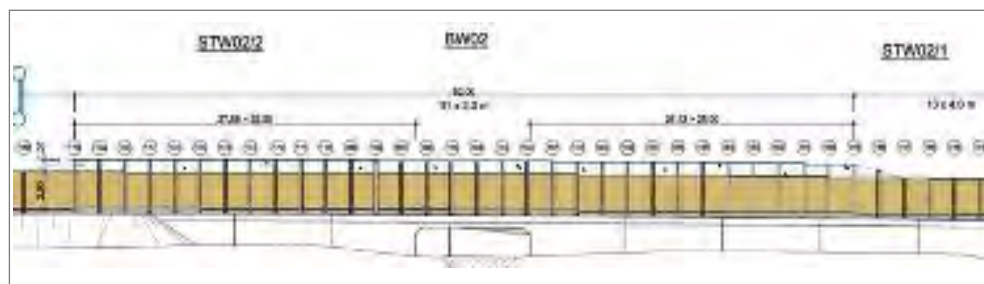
Ausschnitt Bauwerksplan Lärmschutzwand, Quelle: Entwurfsplanung TLBV
